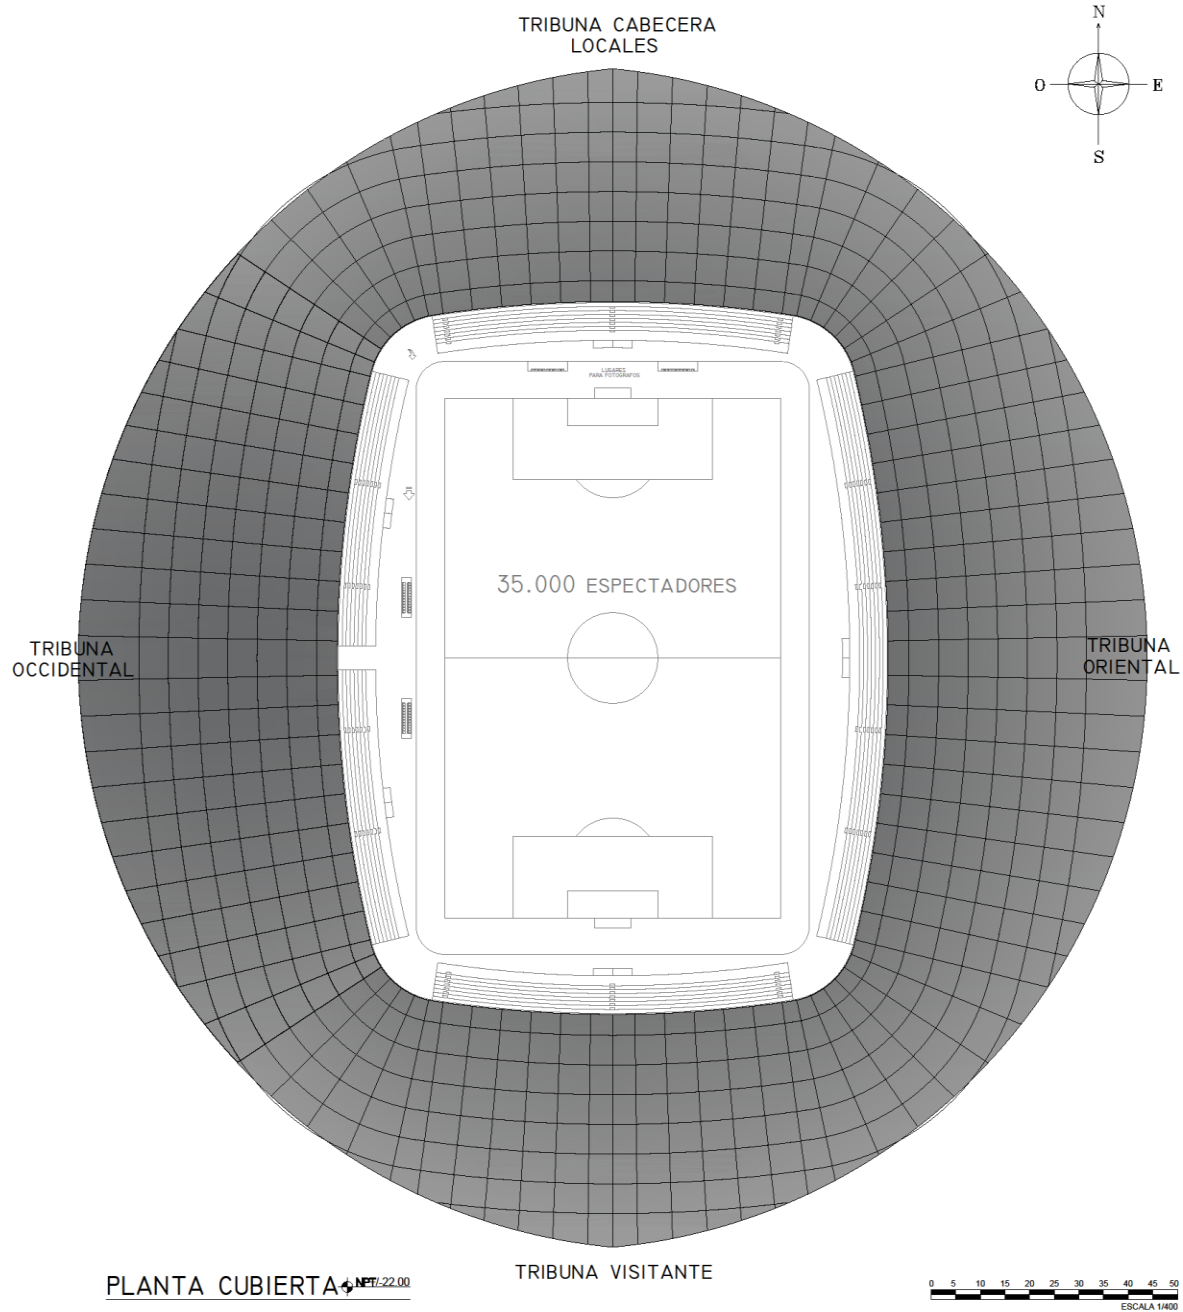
Planta Cubierta / Fuente Elaboración Propia
